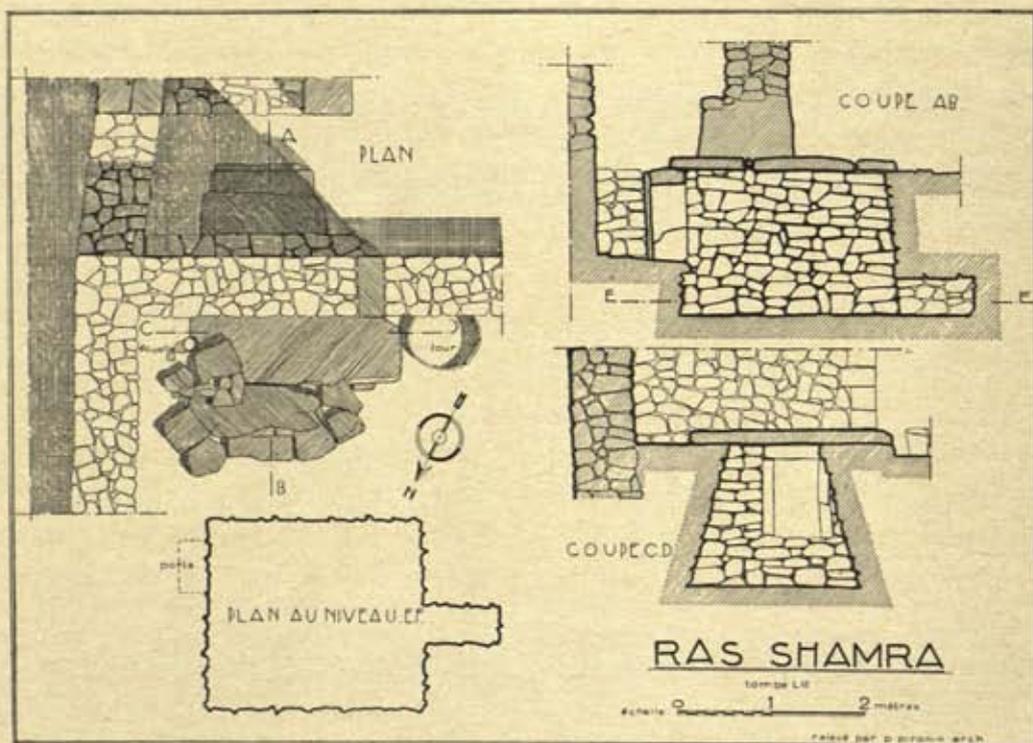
Plans et coupes du caveau LIII. Relevés P. Pironin.
